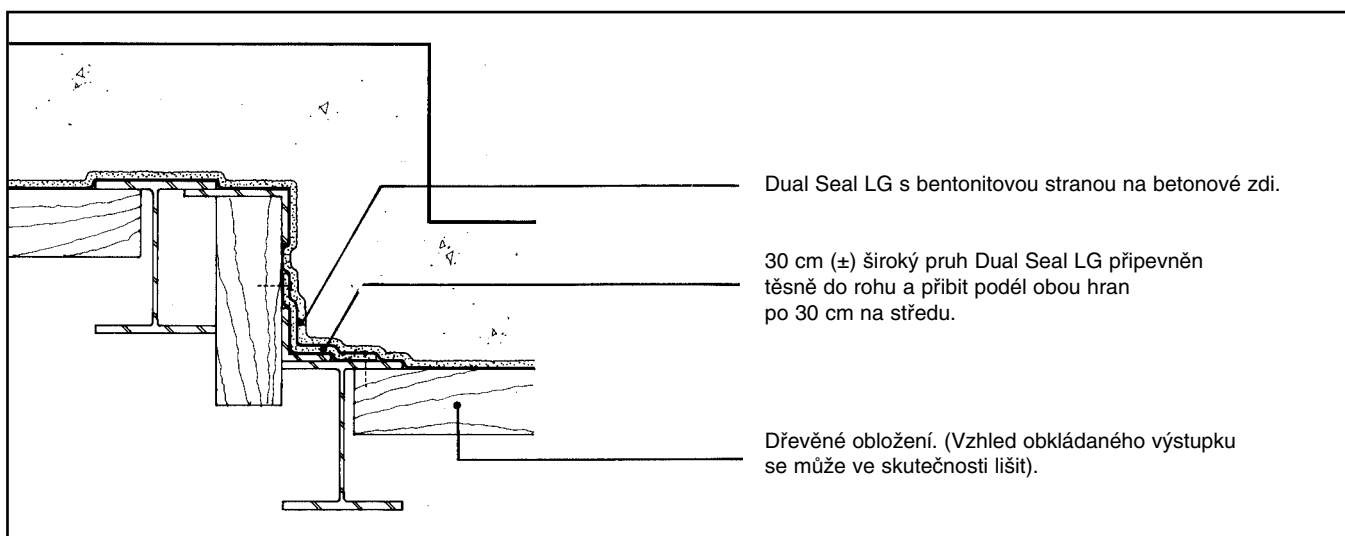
Vlastní instalace torkretu na Dual Seal LG.
